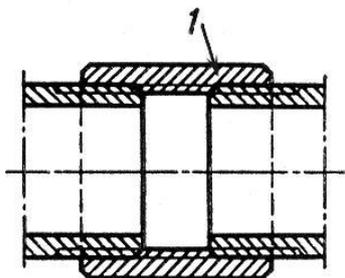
Муфтовое соединение: 1 – резьбовая муфта
